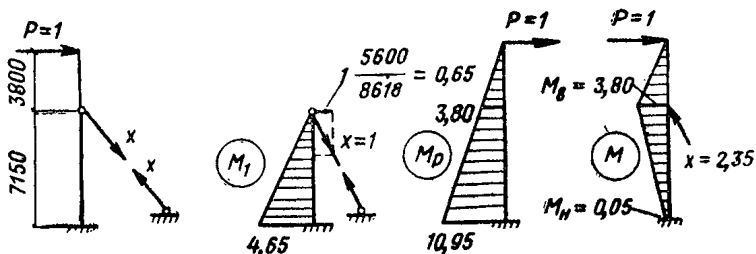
Эпюры моментов в колоннах крайнего продольного ряда каркаса от единичных сил
